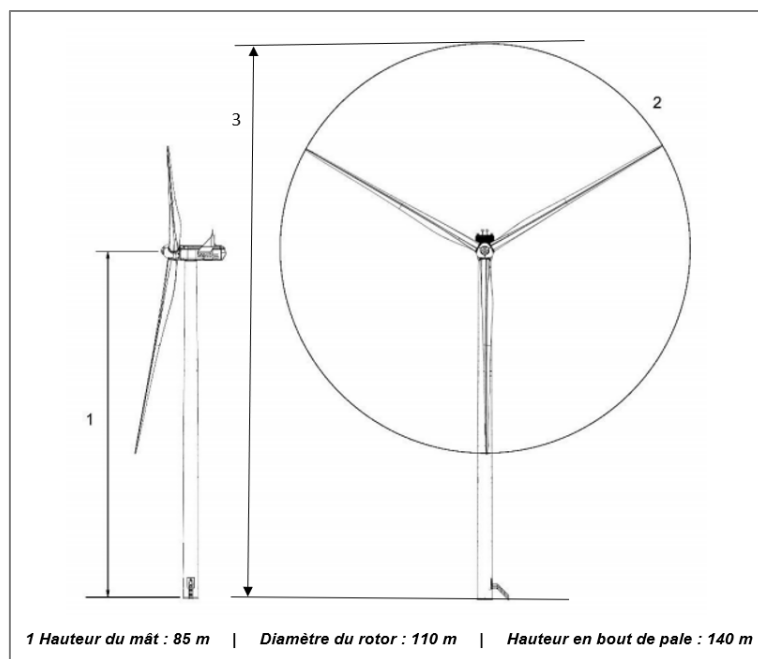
Schéma d'élévation d'une éolienne Vestas V110 Hauteur hors tout 140m
